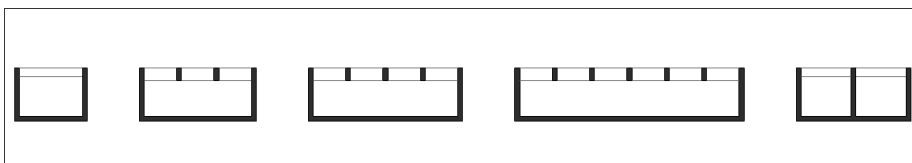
Planta típica de torre unidireccional. Elaboración propia (Roaf, 1988)
